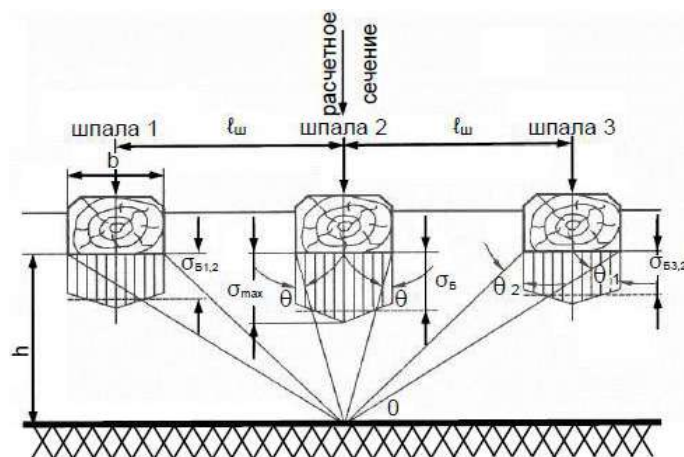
Расчетная схема определения напряжений на основной площадке земляного полотна
